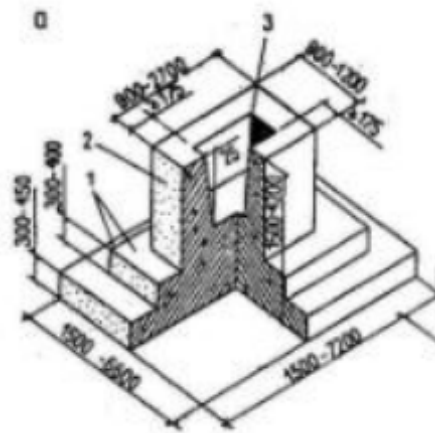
Монолітний стовповий залізобетонний фундамент, стаканного типу
